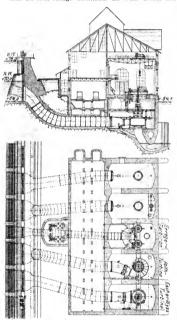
Das Maschinenhaus der Glommen-Aulage. Querschnitt bei der Escher Wyss-Turbine und Grundriss. — 1:500.
